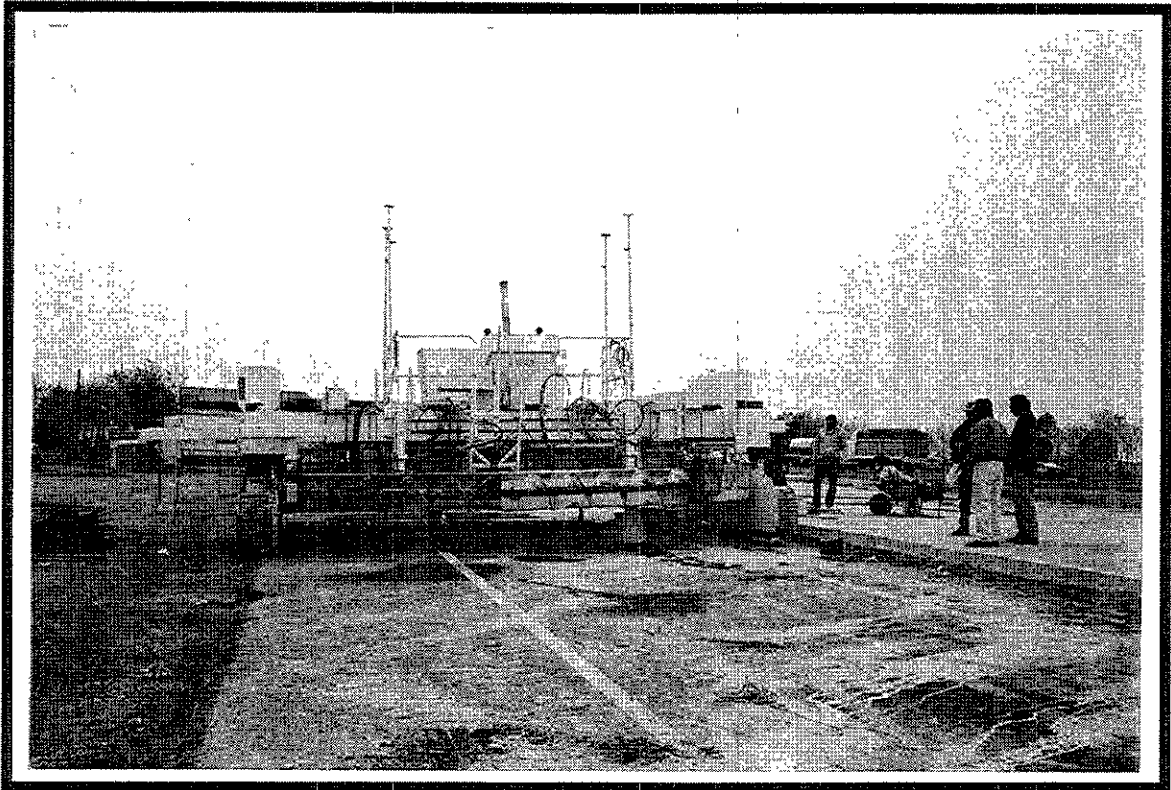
Pavimentadora de concreto hidráulico autopropulsada y con cimbra deslizante integrada, para anchos hasta de 8 metros.
